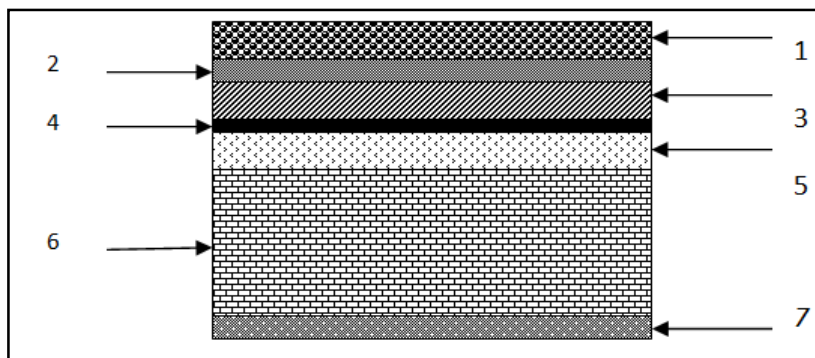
Coupe transversale au niveau de plancher étage terrasse
